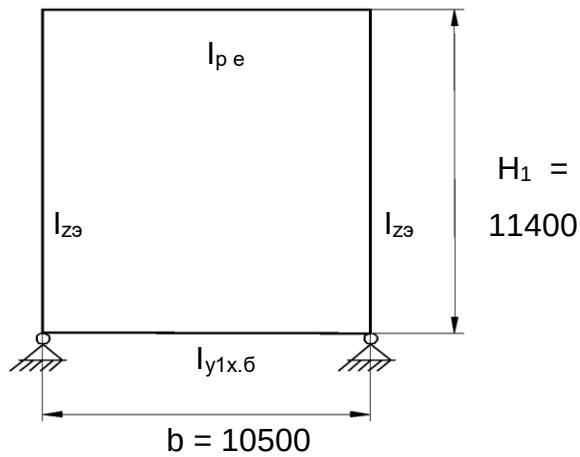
Розрахункова схема поздовжньої рами з боку довгої консолі
